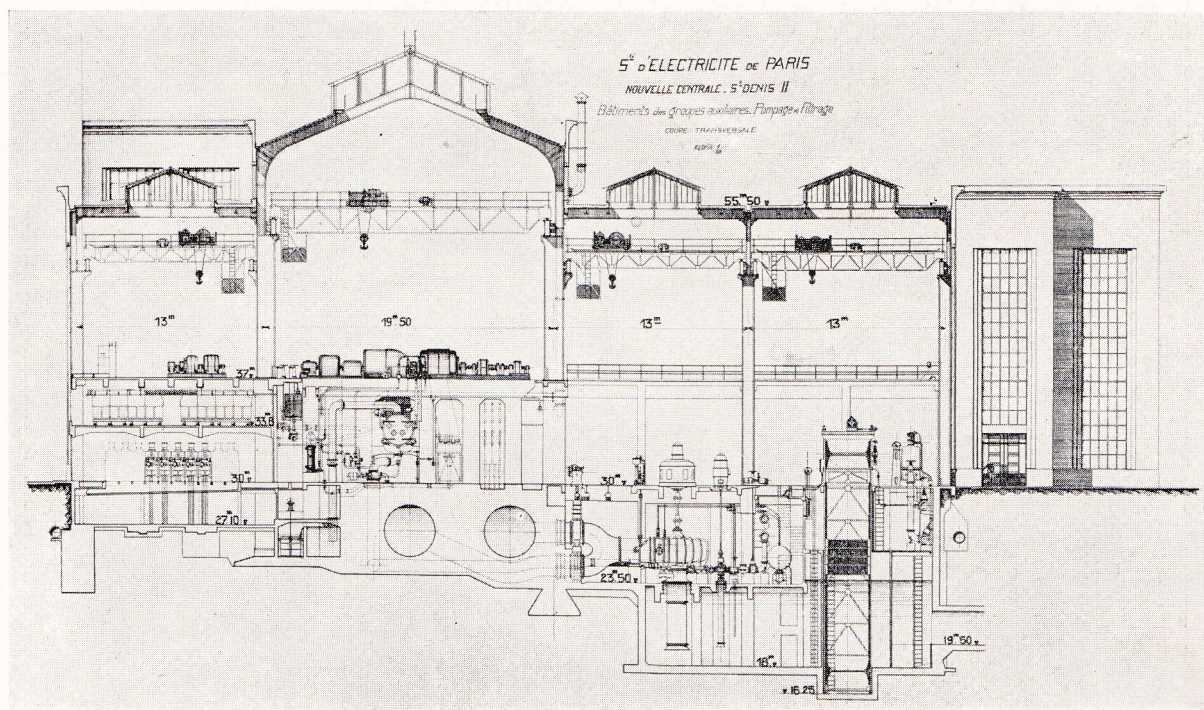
Coupe transversale des bâtiments de l'usine par la salle des groupes auxiliaires.
